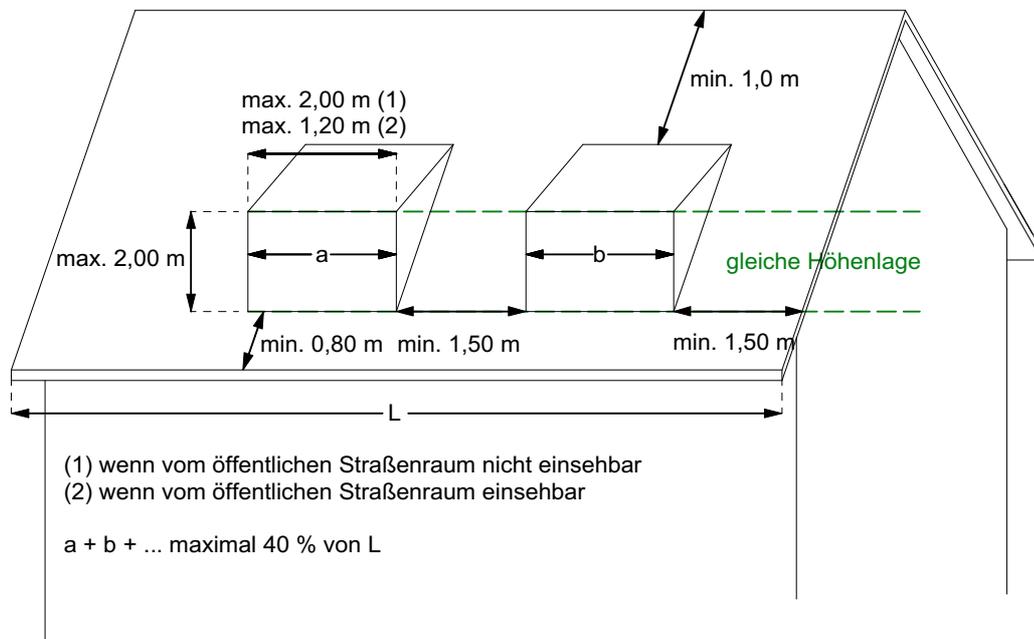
Einzuhaltende Mindestabstände bei Dachaufbauten - gilt analog für Dacheinschnitte
